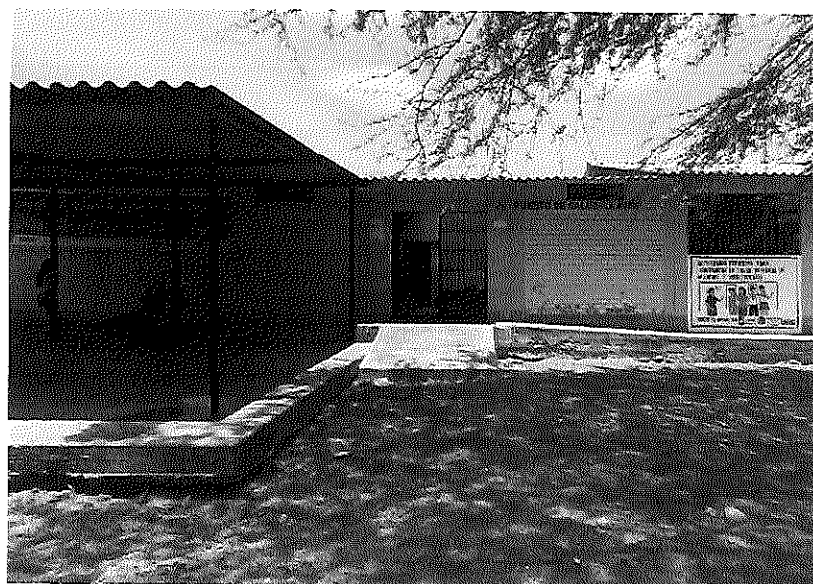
Vista de infraestructura del Puesto de Salud La Rita, construido.
